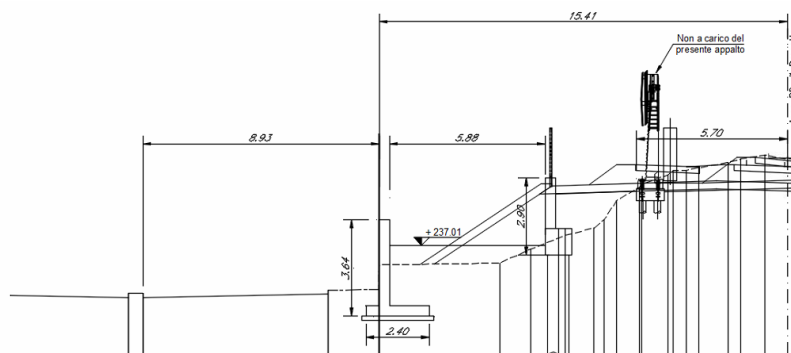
Sezione trasversale piazzale nell'area compresa tra linea BG-PSP e BG -Treviglio
